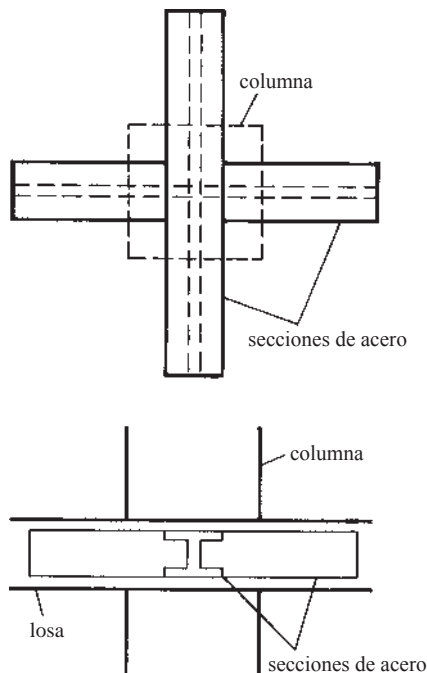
Refuerzo con crucetas de cortante en losas y columnas.
